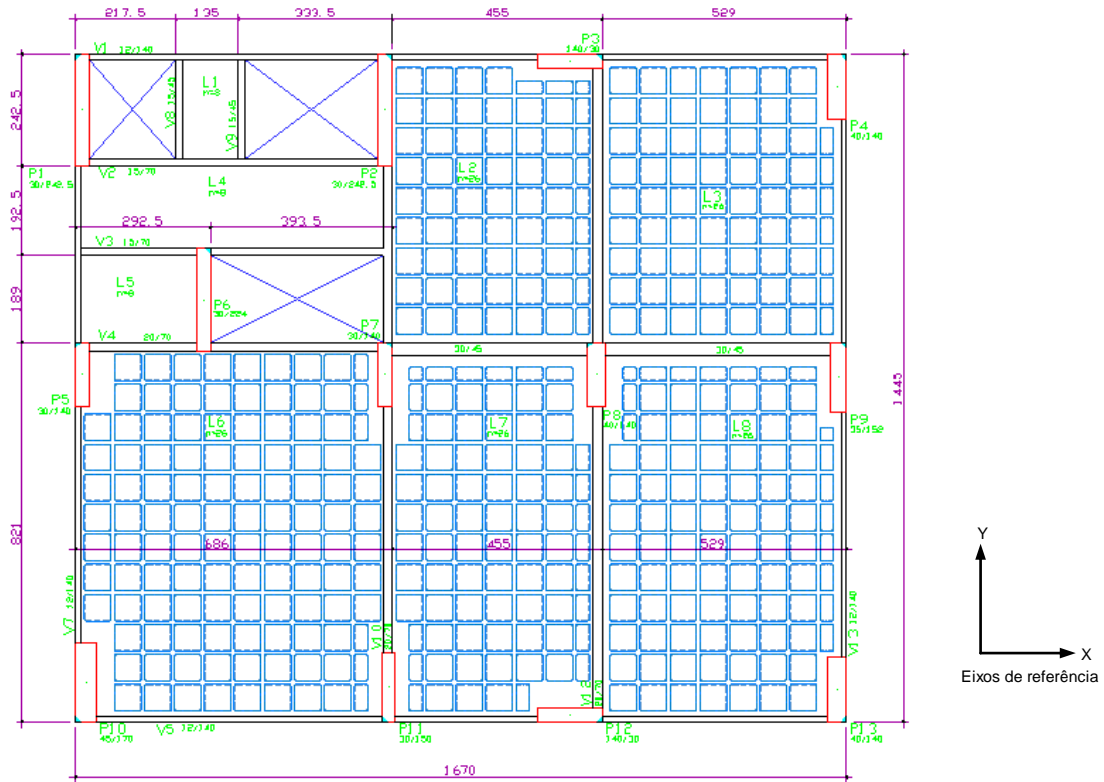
Planta baixa da forma do pavimento-tipo – Edifício 3
